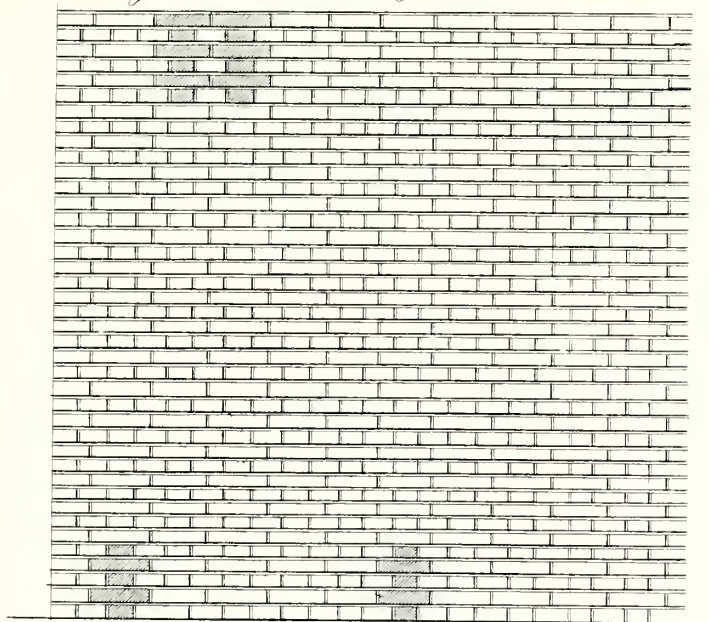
(Siehe Grundriss Fig. 2. Taf. I. C u. D.)
